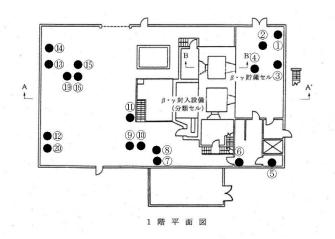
β · γ 固体処理棟Ⅲ (1階) 平面図及び可燃物配置
